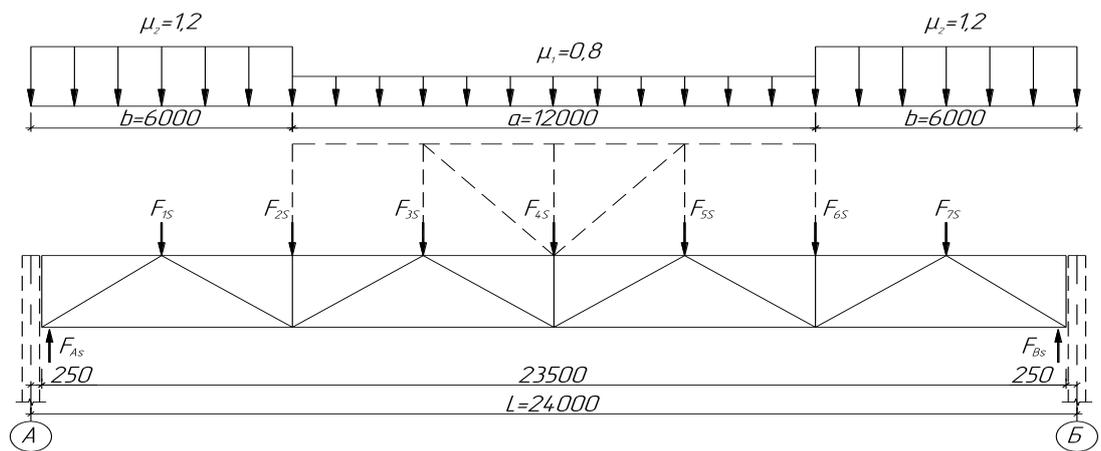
Схема первого варианта снеговой нагрузки на стропильную ферму
